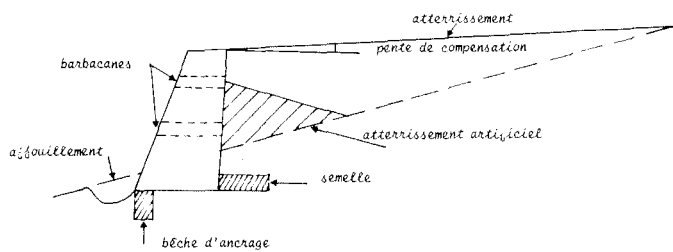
SEUIL EN MACONNERIE - coupe au niveau de la cuvette
